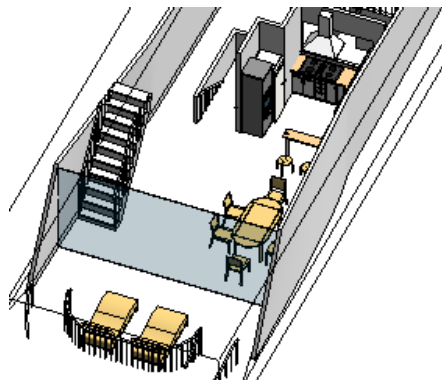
Terraza y comedor de la cubierta principal en Revit.
